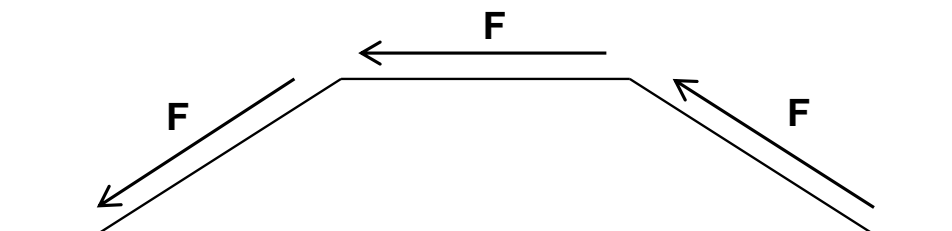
Disposición de las fuerzas F debidas al cortante en vigas de alma corrugada
